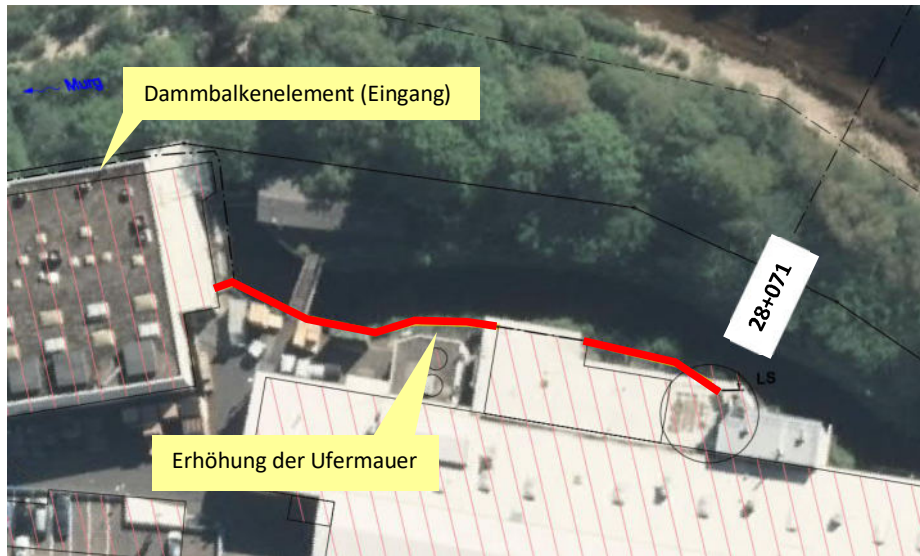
Lageplan Maßnahmen M2, Bereich Fa. Röchling
